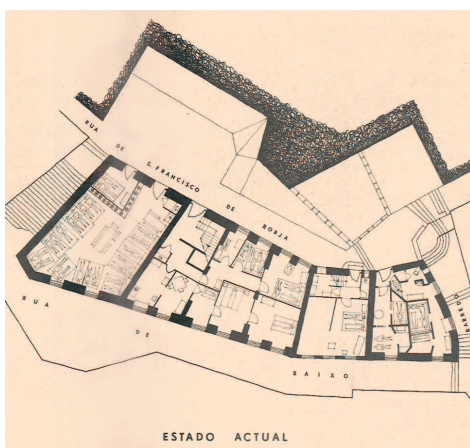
Estudo de renovação urbana do Barredo, levantamento da situação existente e proposta de intervenção (planta do nível I, quarteirão Q1)
